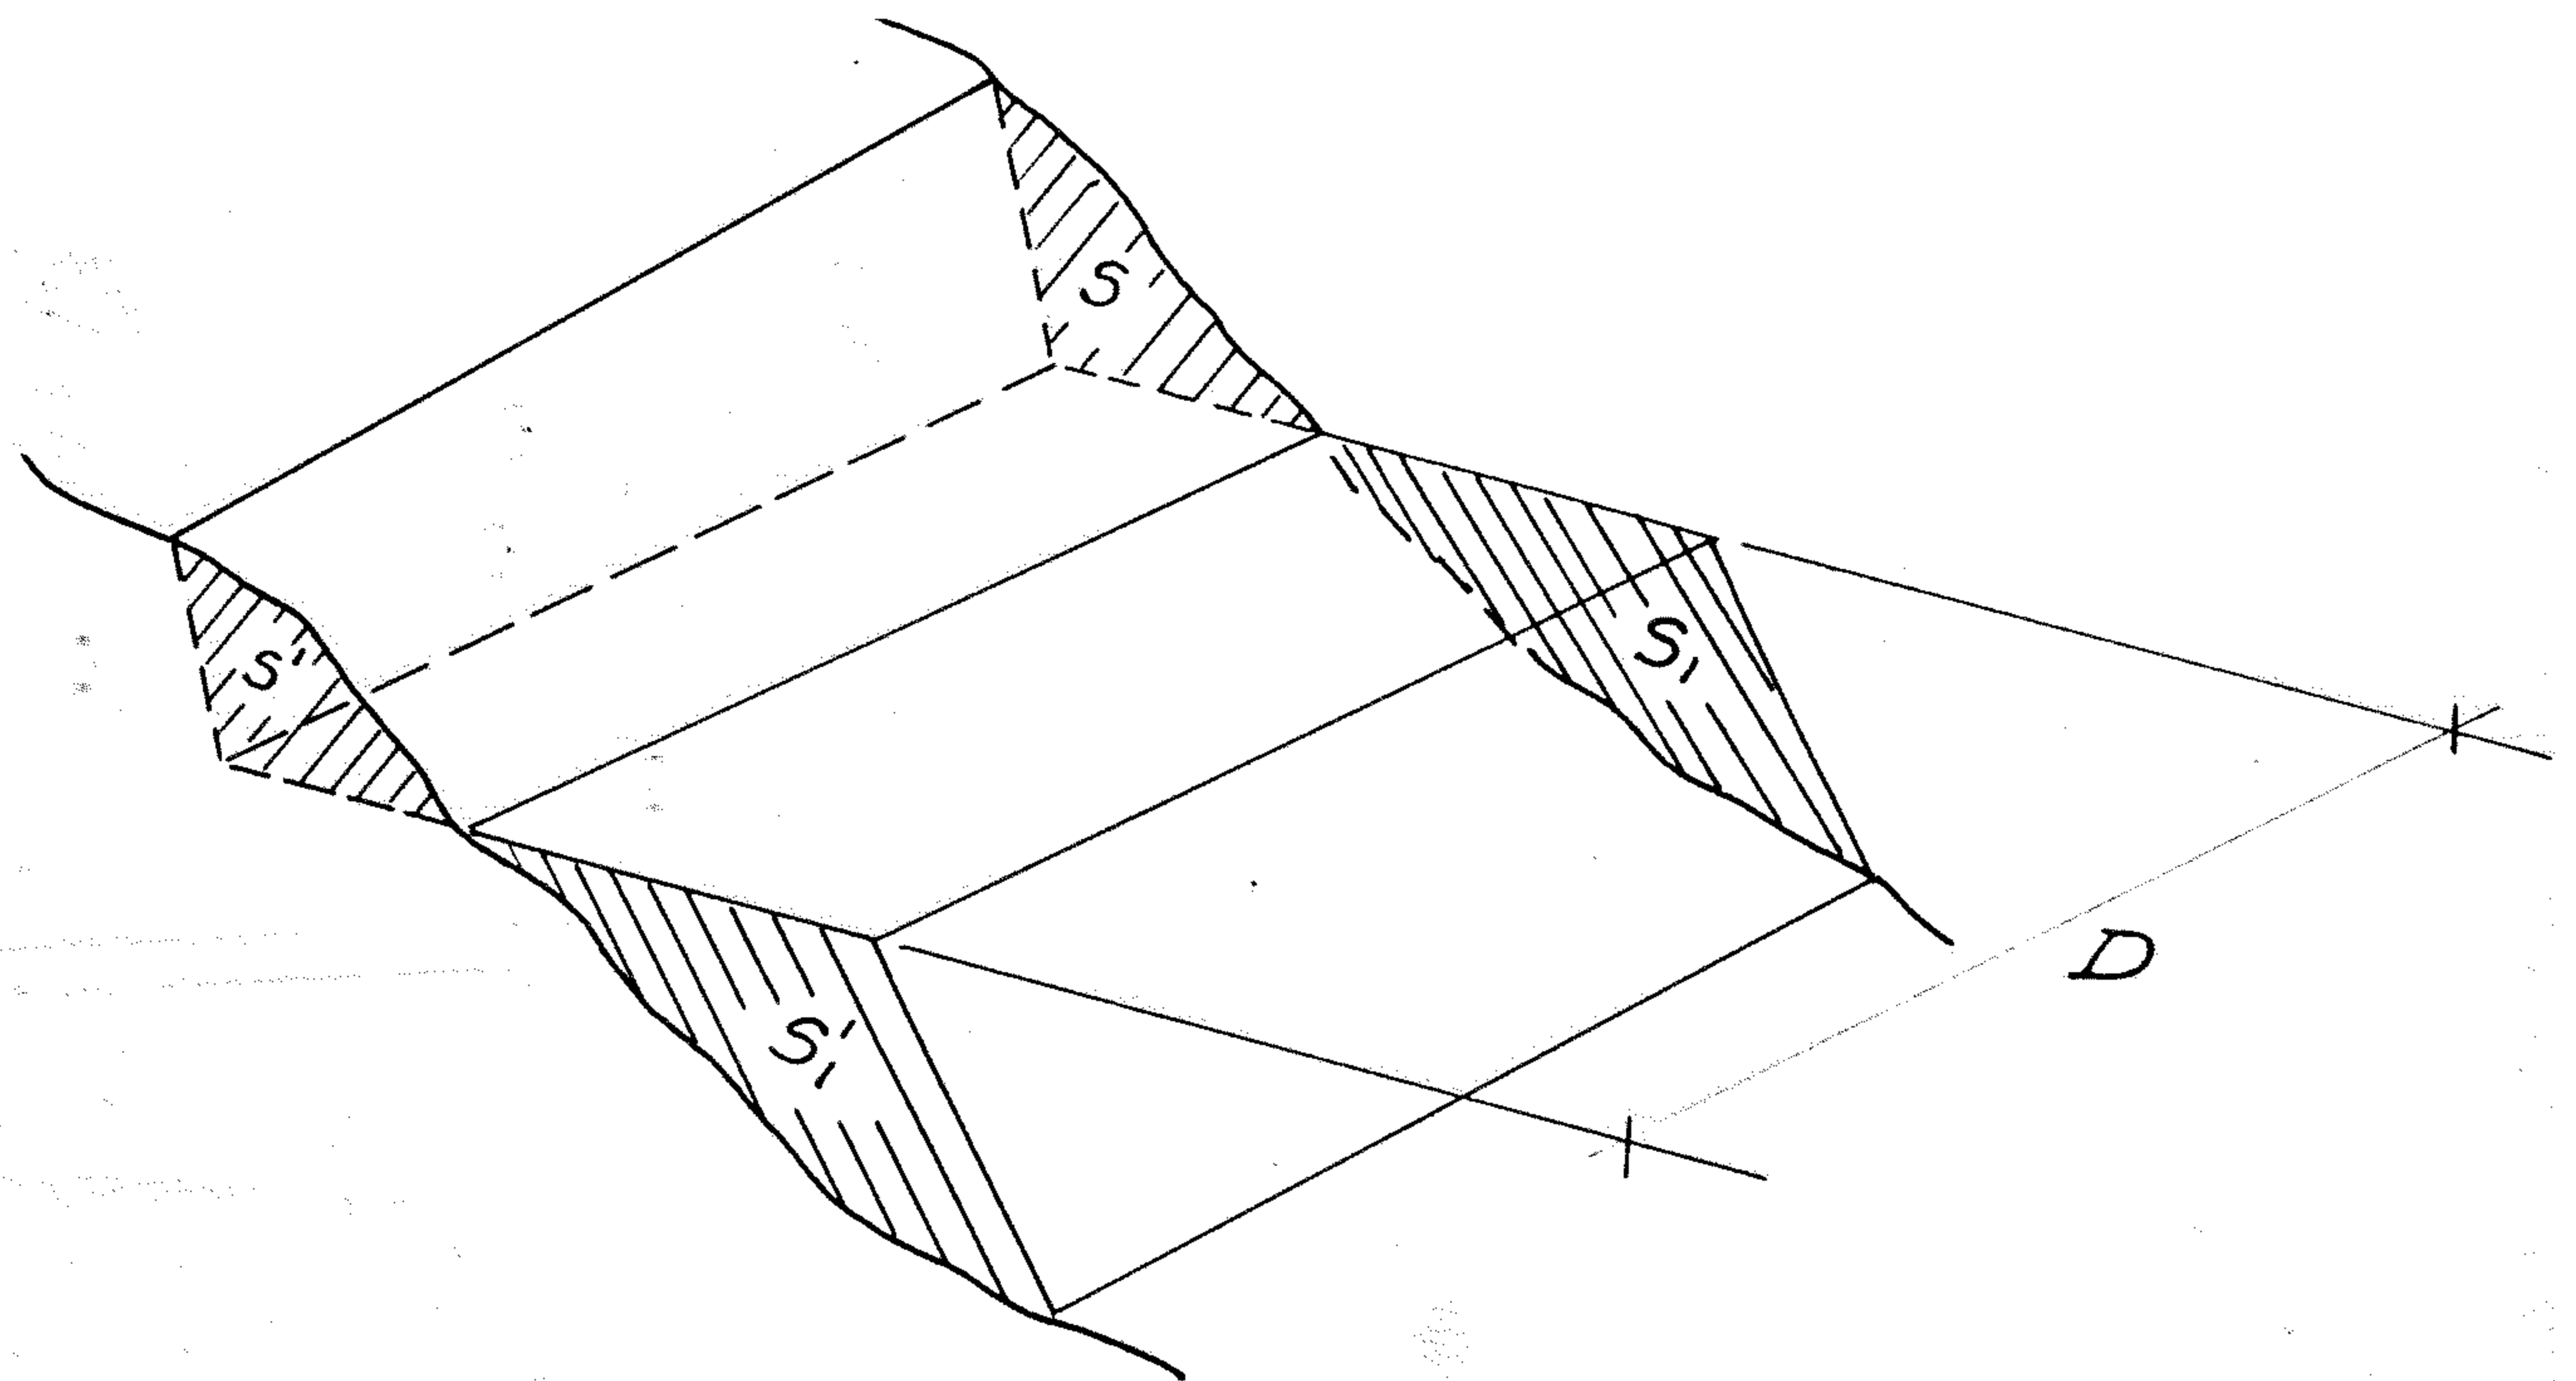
LAS DOS SECCIONES EN MEDIA LADERA
